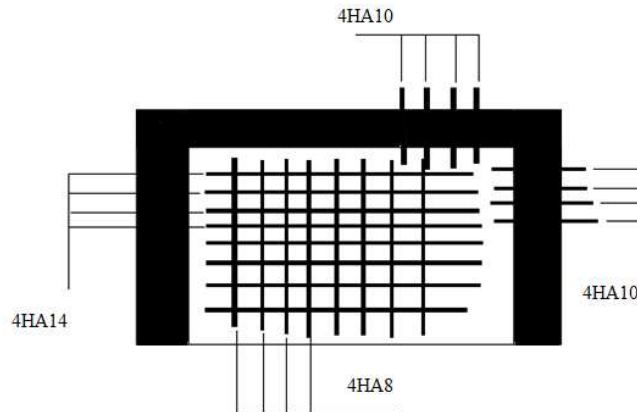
Schéma de ferrailage de la dalle plein sur trois appuis
